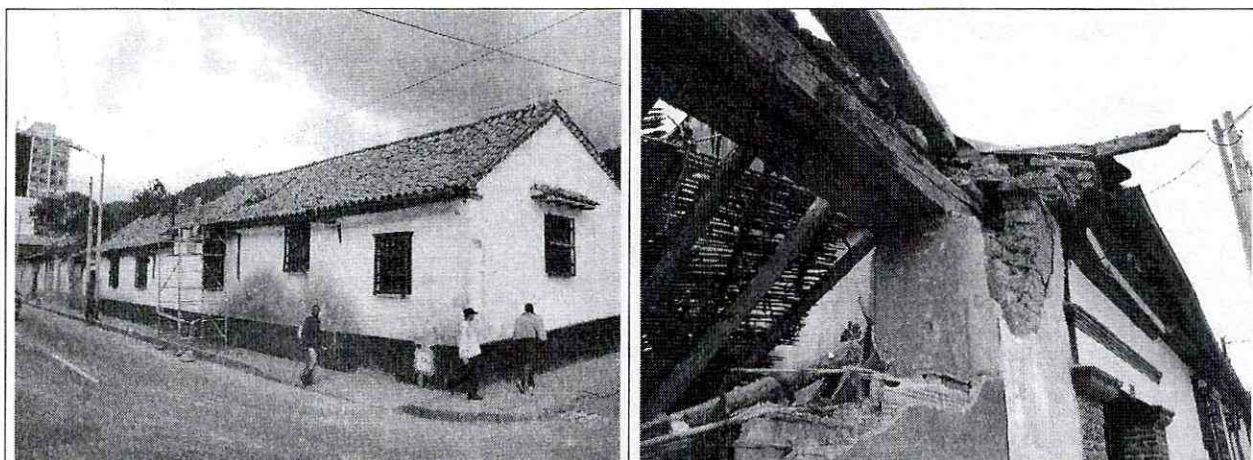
Vista de la edificación de un nivel (costado occidental) de la Casa Parroquial de Santa Bárbara, Carrera 7 No. 5-26.
